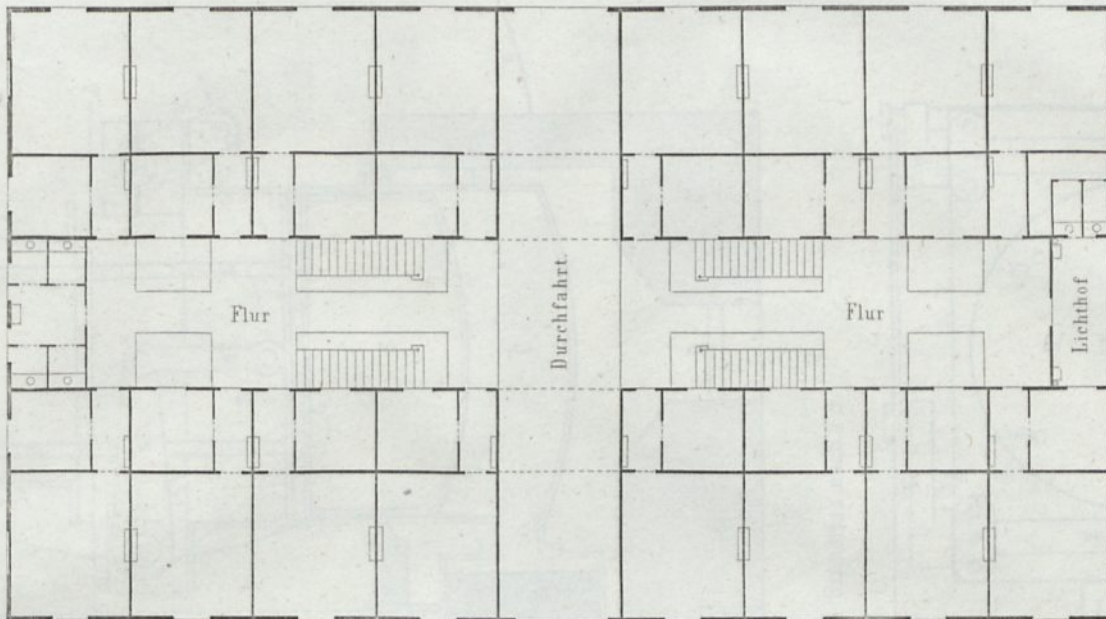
Grundriss von A, (2^{tes} Stockwerk)
